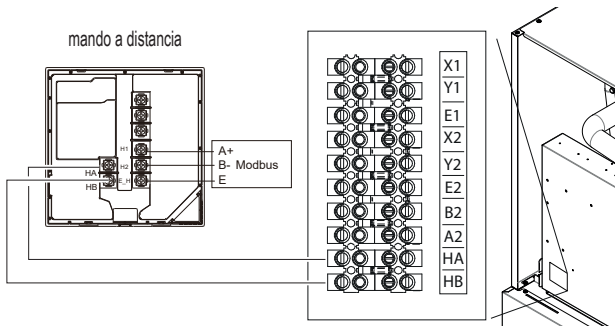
Cablaggio del comando remoto con unità esterna R290
